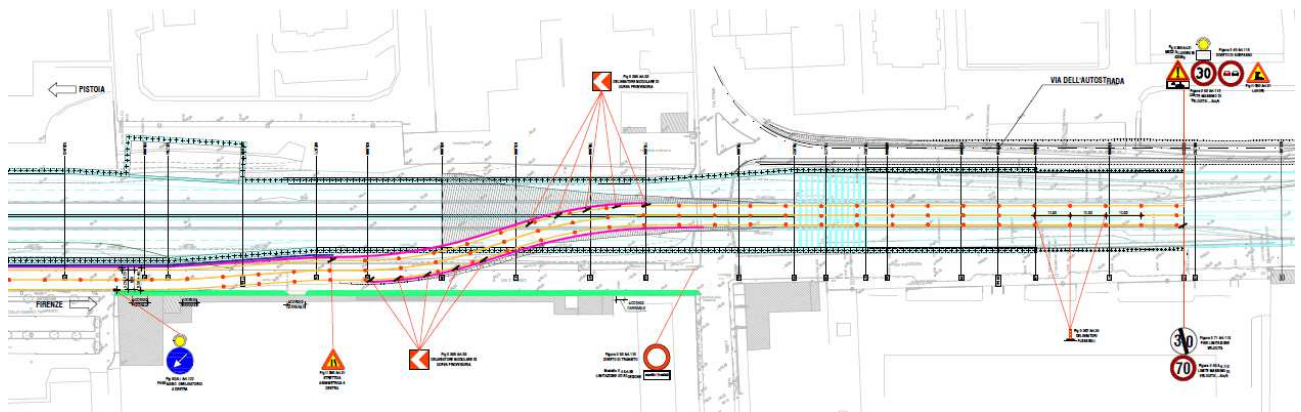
Planimetria deviazione provvisoria fase 2 (parte 2)
